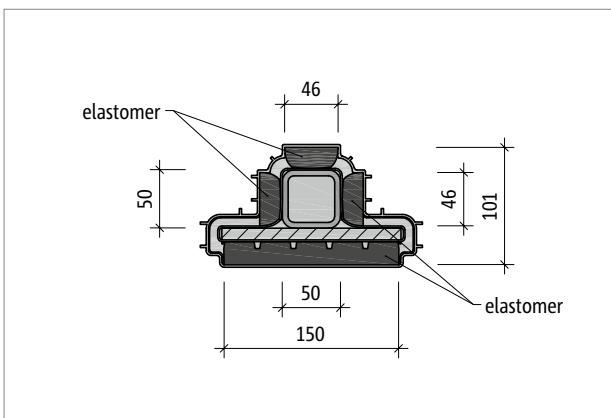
Schöck Tronsole® tip P: tloris proizvoda
